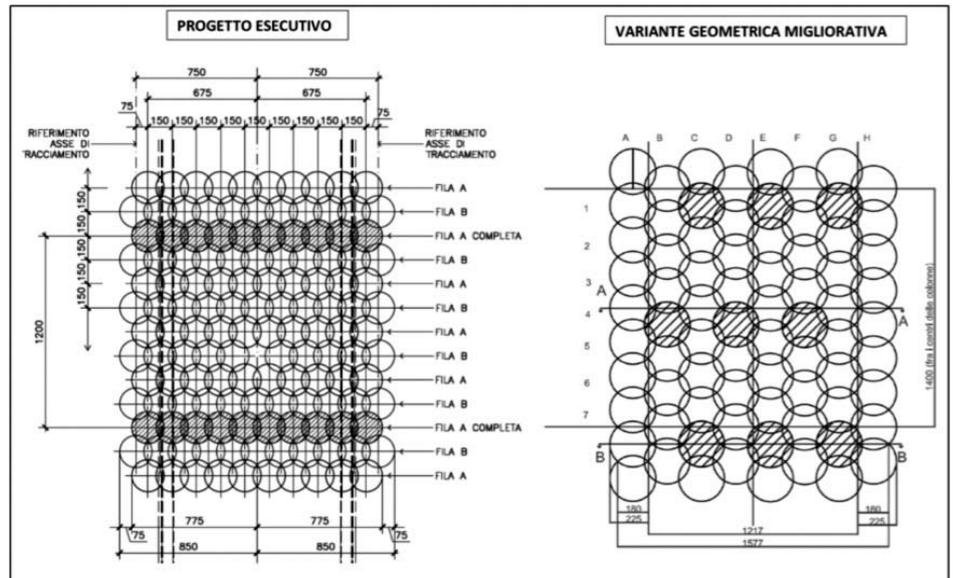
Planimetria di confronto “Progetto Esecutivo - Variante Geometrica Migliorativa”; intervento di gettinizzazione / Picture 2: Planimetry comparison “Executive Project – Geometrical Enhancement Modification”; jet grouting intervention.
